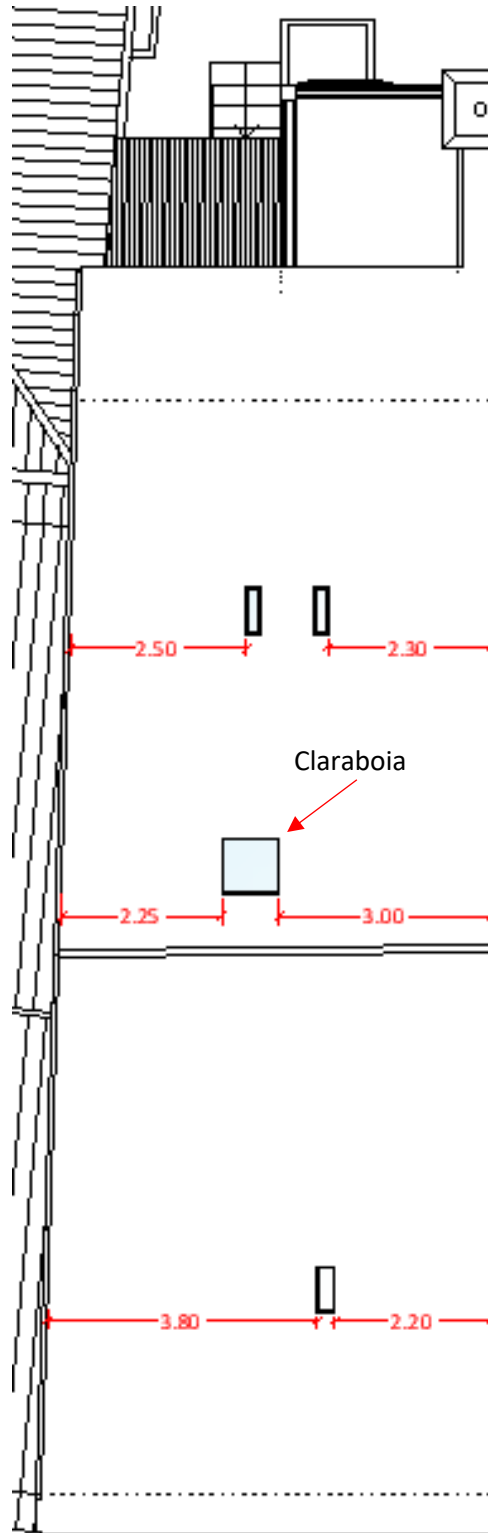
Planta baixa da cobertura com as cotas entre os elementos envidraçados e a parede (SRU, 2023).
